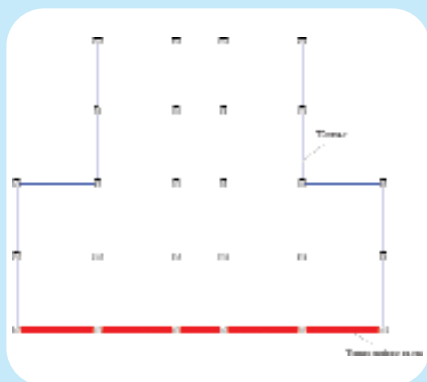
Edificio con distribuzione delle tamponature irregolare in pianta.
